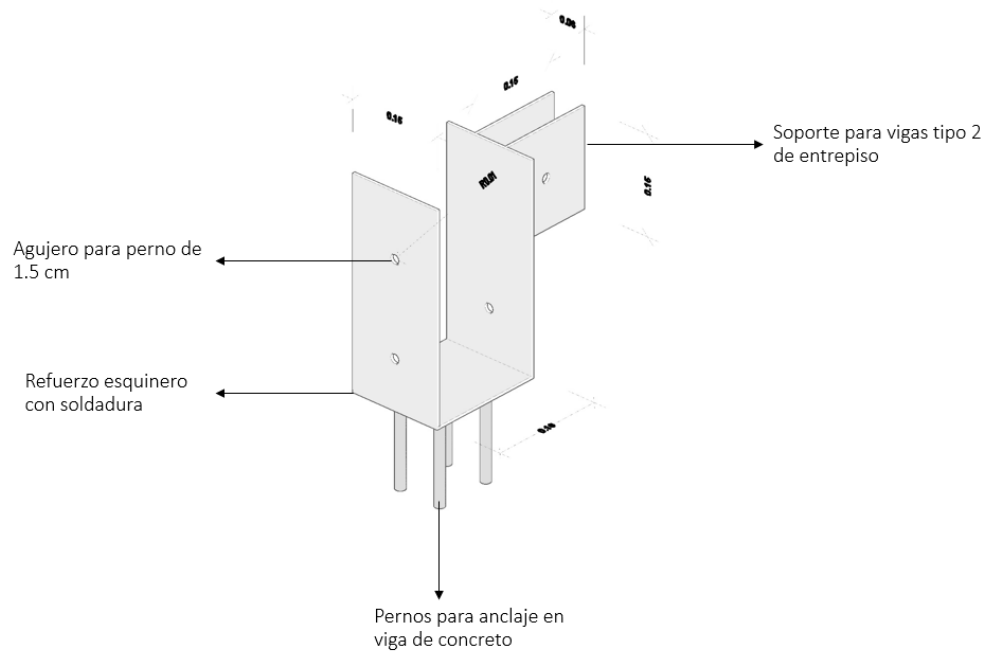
Detalle platina de unión tipo 1. Columna espaciada, cimentación y vigas entrepiso.
